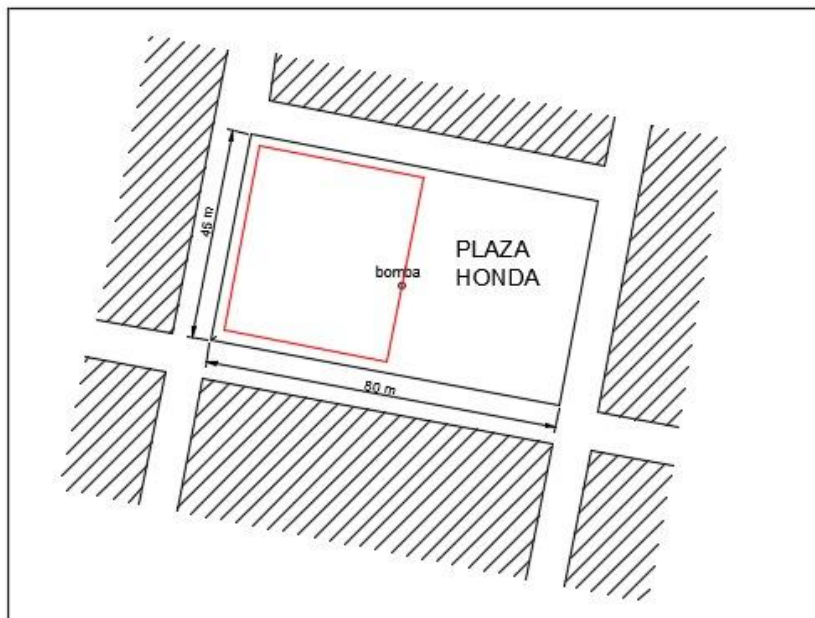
Croquis del sistema de drenaje en la Plaza Honda
